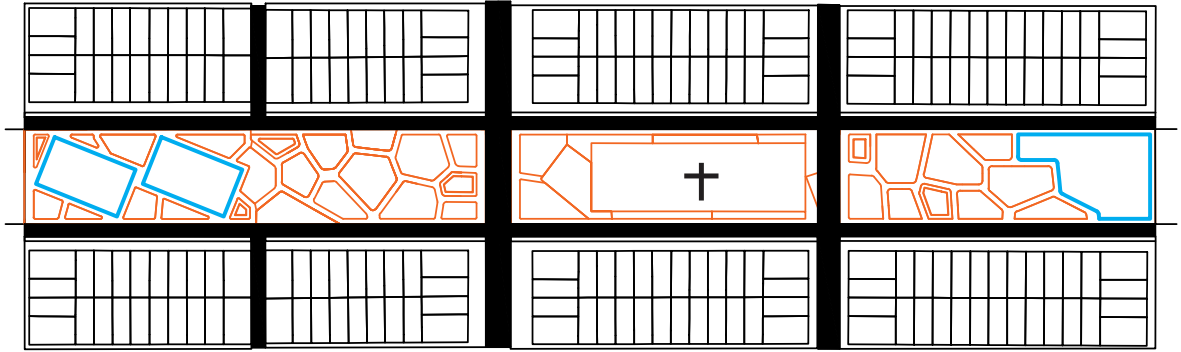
planimetría planta Parque lineal distribución de espacios.
